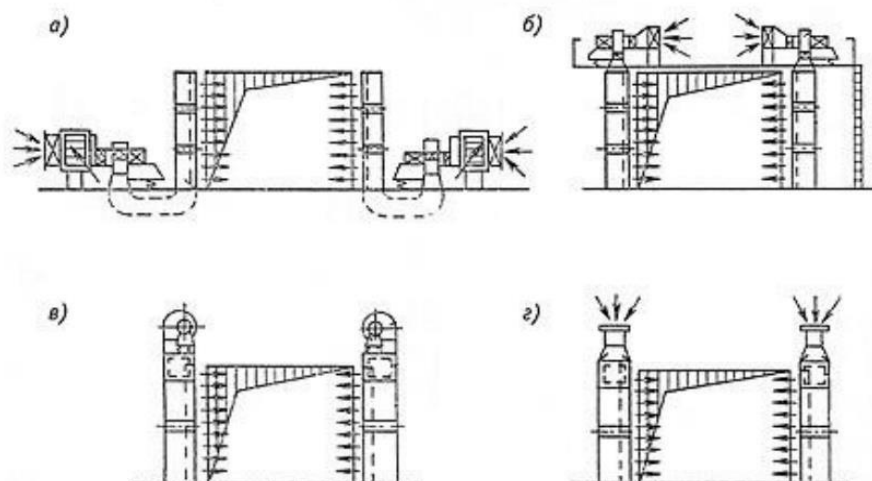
Схемы установки агрегатов завес шиберующего типа
